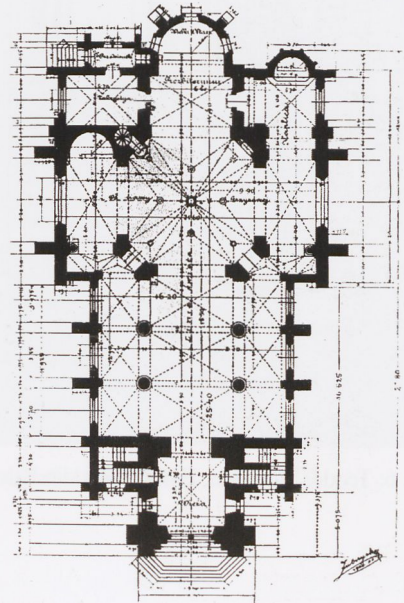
Jan Sas Zubrzycki, Entwurf für die Kirche in Cieklin, Grundriss, 1900
